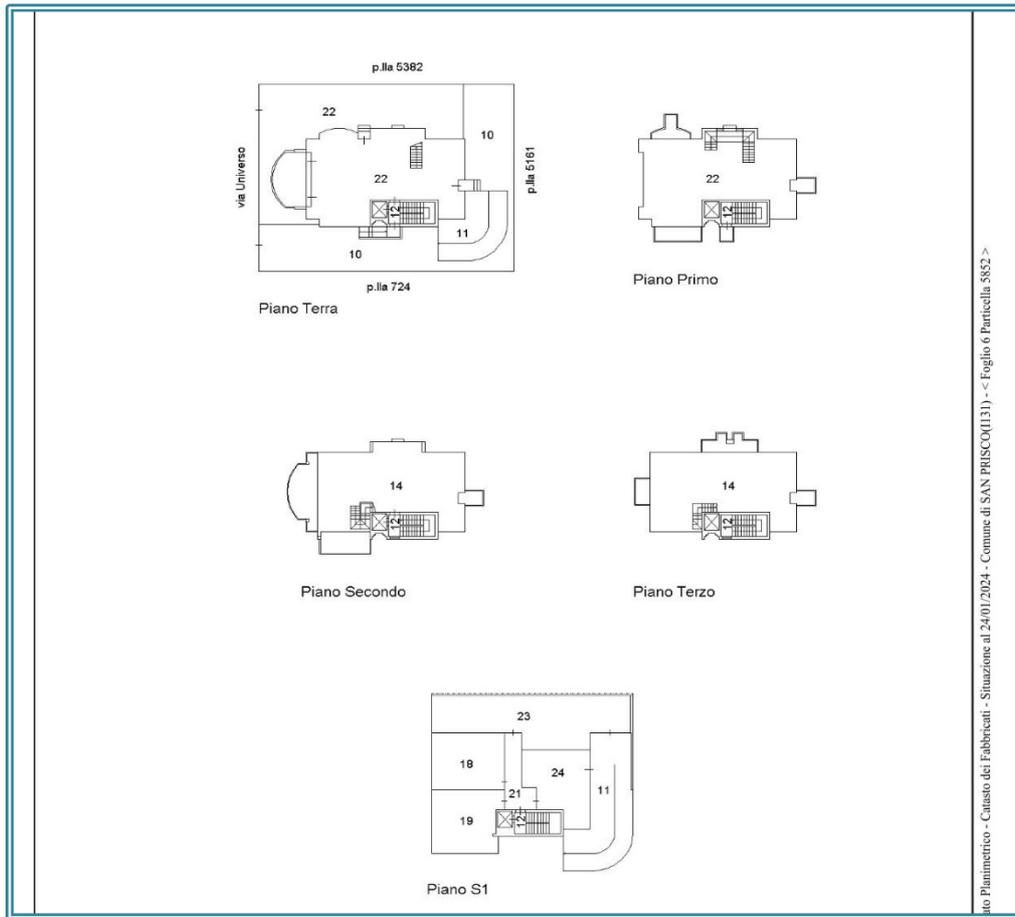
Elaborato planimetrico (LOTTE 1,2,3,4,5,6)
